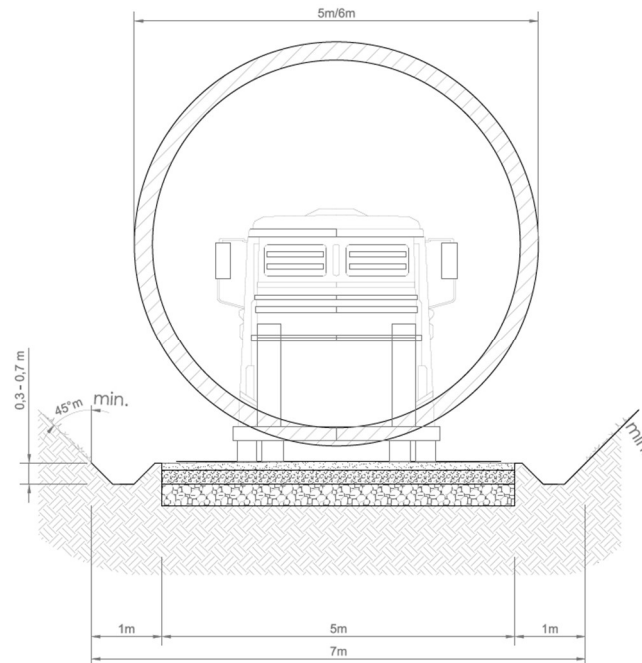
Sezione stradale tipo con rappresentazione dell'ingombro careggiata del trasporto
